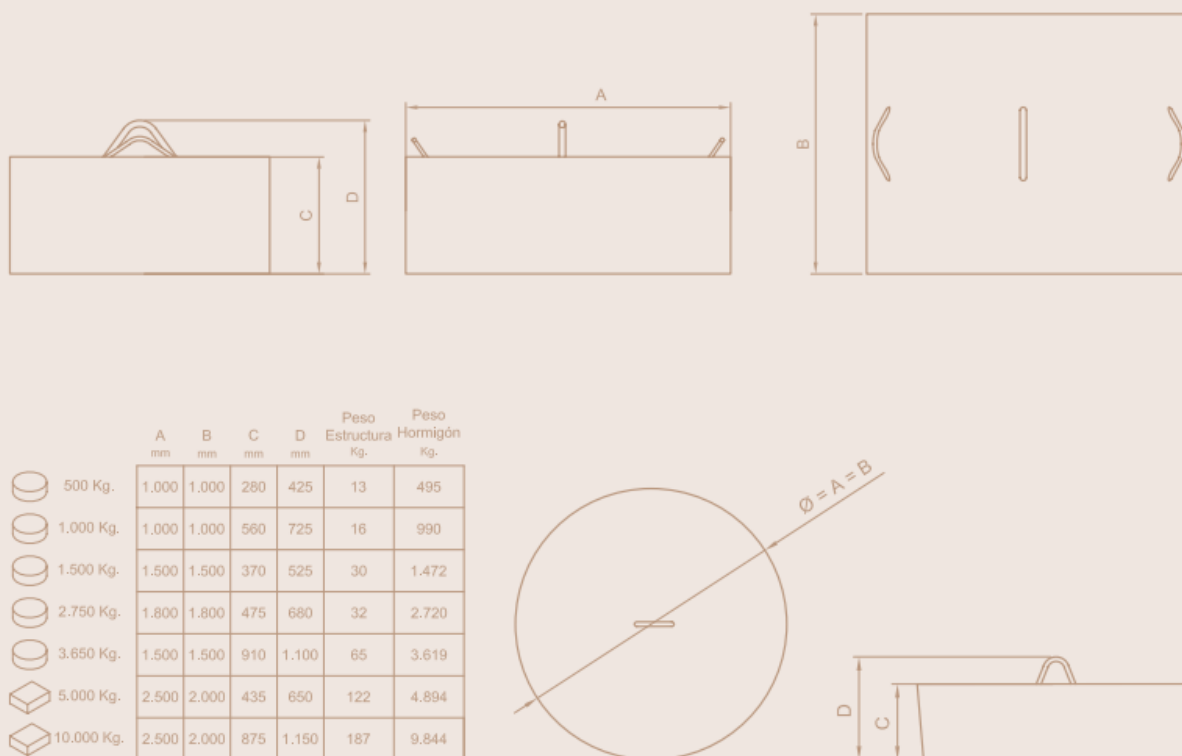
Dimensiones estándar lastres hormigón. Fuente: catálogo ITP
